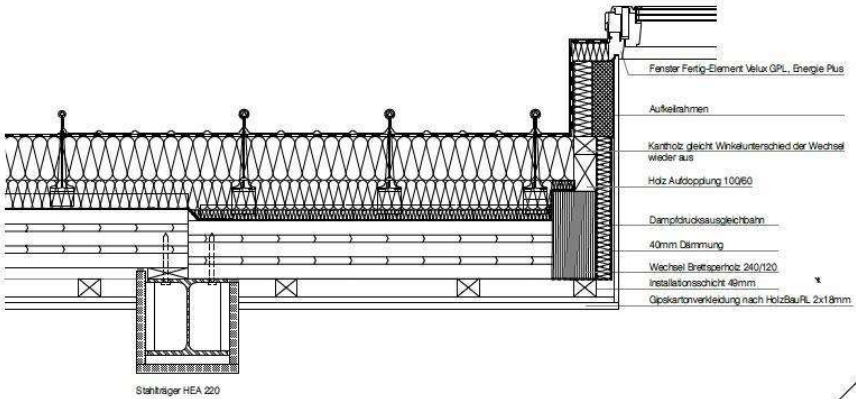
Horizontalschnitt DFF mit Dachanschluss
